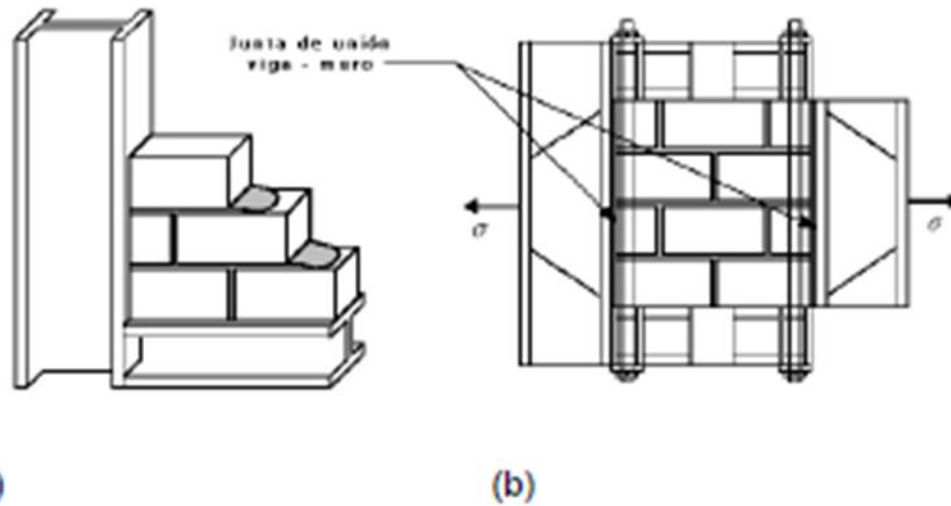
Ensayo para evaluar la resistencia a tensión de la mampostería paralela a las juntas horizontales, Backes (1985): a) fabricación del panel a ensayar; b) panel antes de ser girado 90° para su ensayo. Adaptado de (Vlviescas, 2009)
